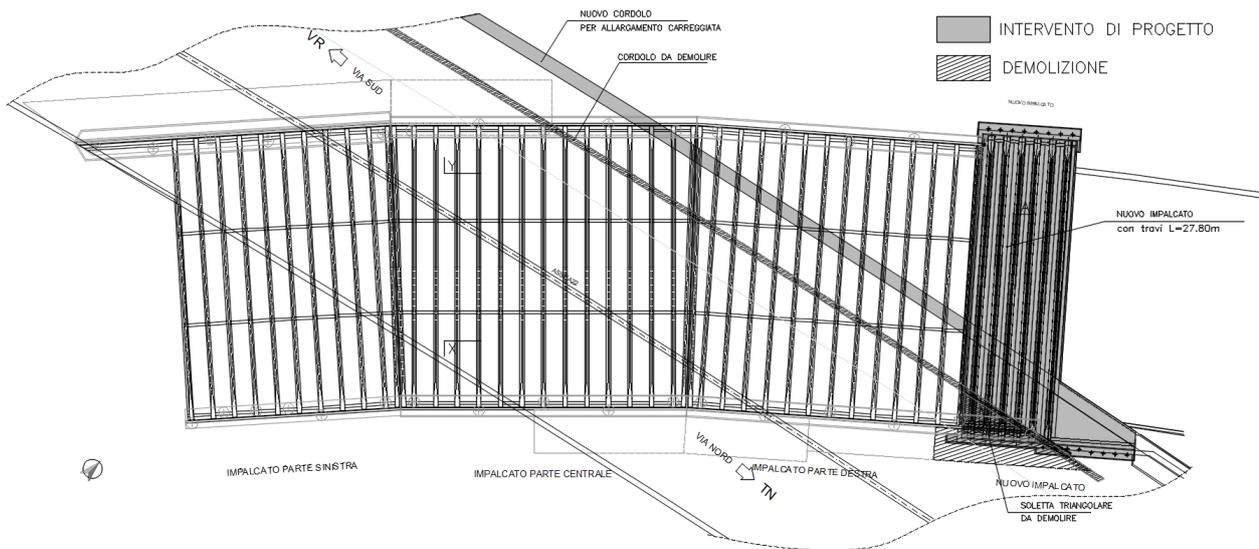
Pianta dell'impalcato del ponte sul canale S.I.M.A. nella configurazione di progetto
